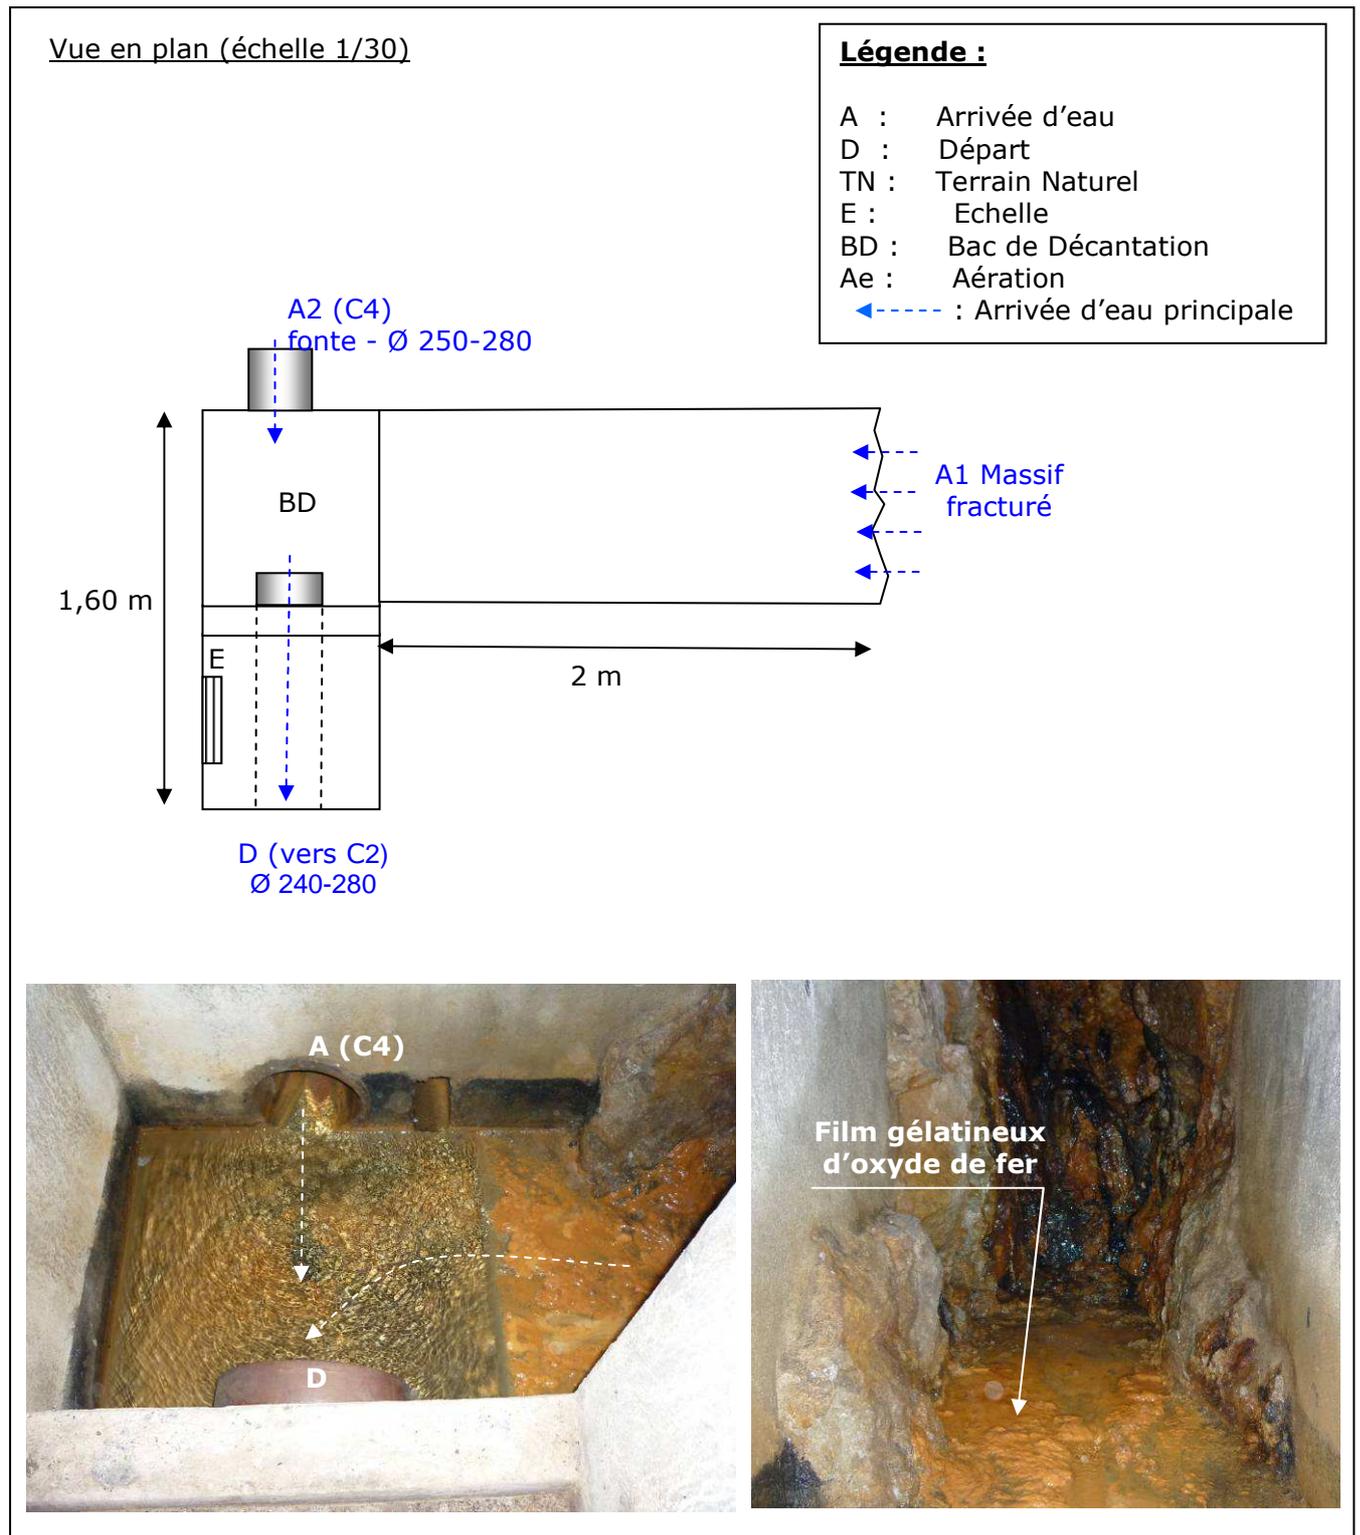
Vue en plan de l'ouvrage de Lempret C3
